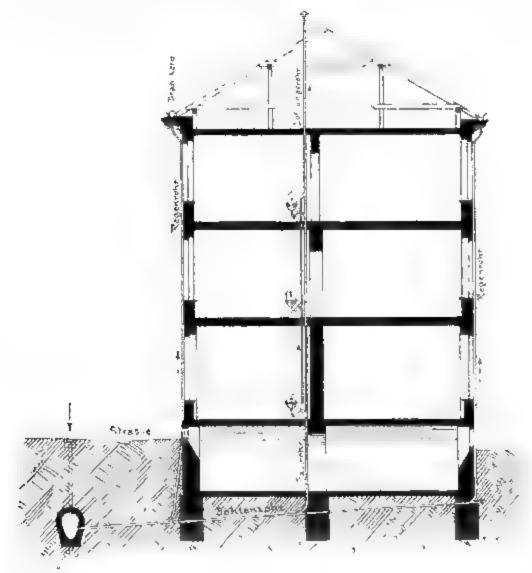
Lüftung der Hausentwasserungsleitungen.
